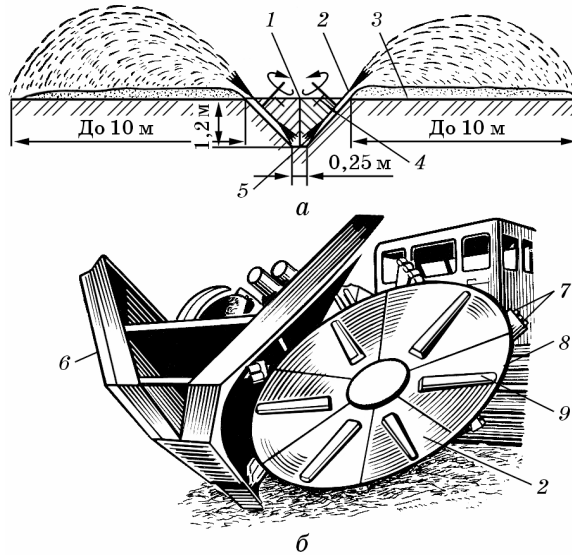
Фрезерний каналокочач КФН-1200А:
